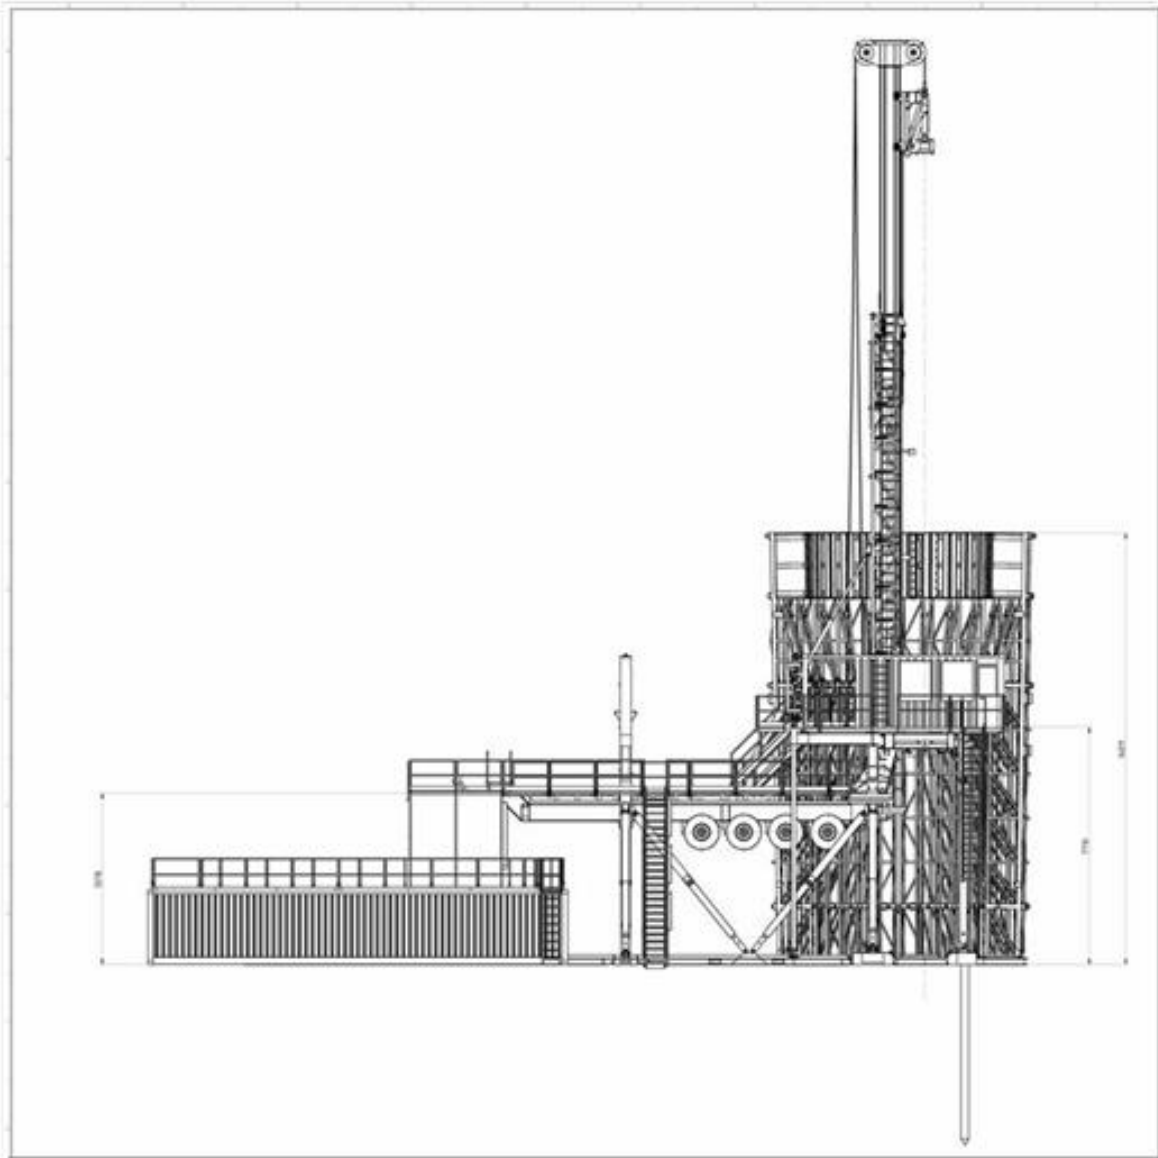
Sezione e dimensioni dell'impianto/Rig section and size
